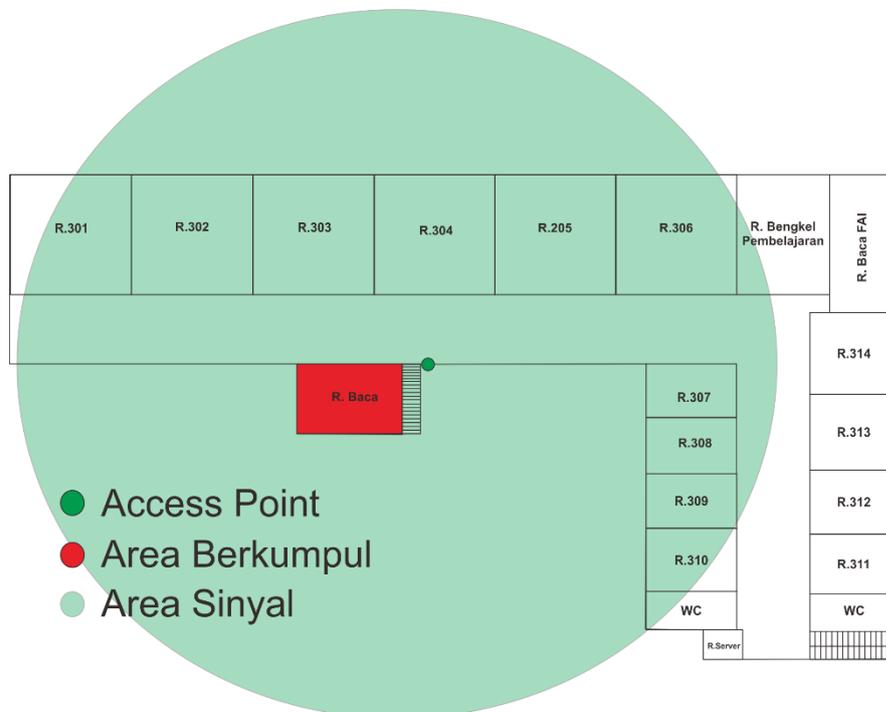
5. Denah Gedung Teknik Lantai 2
